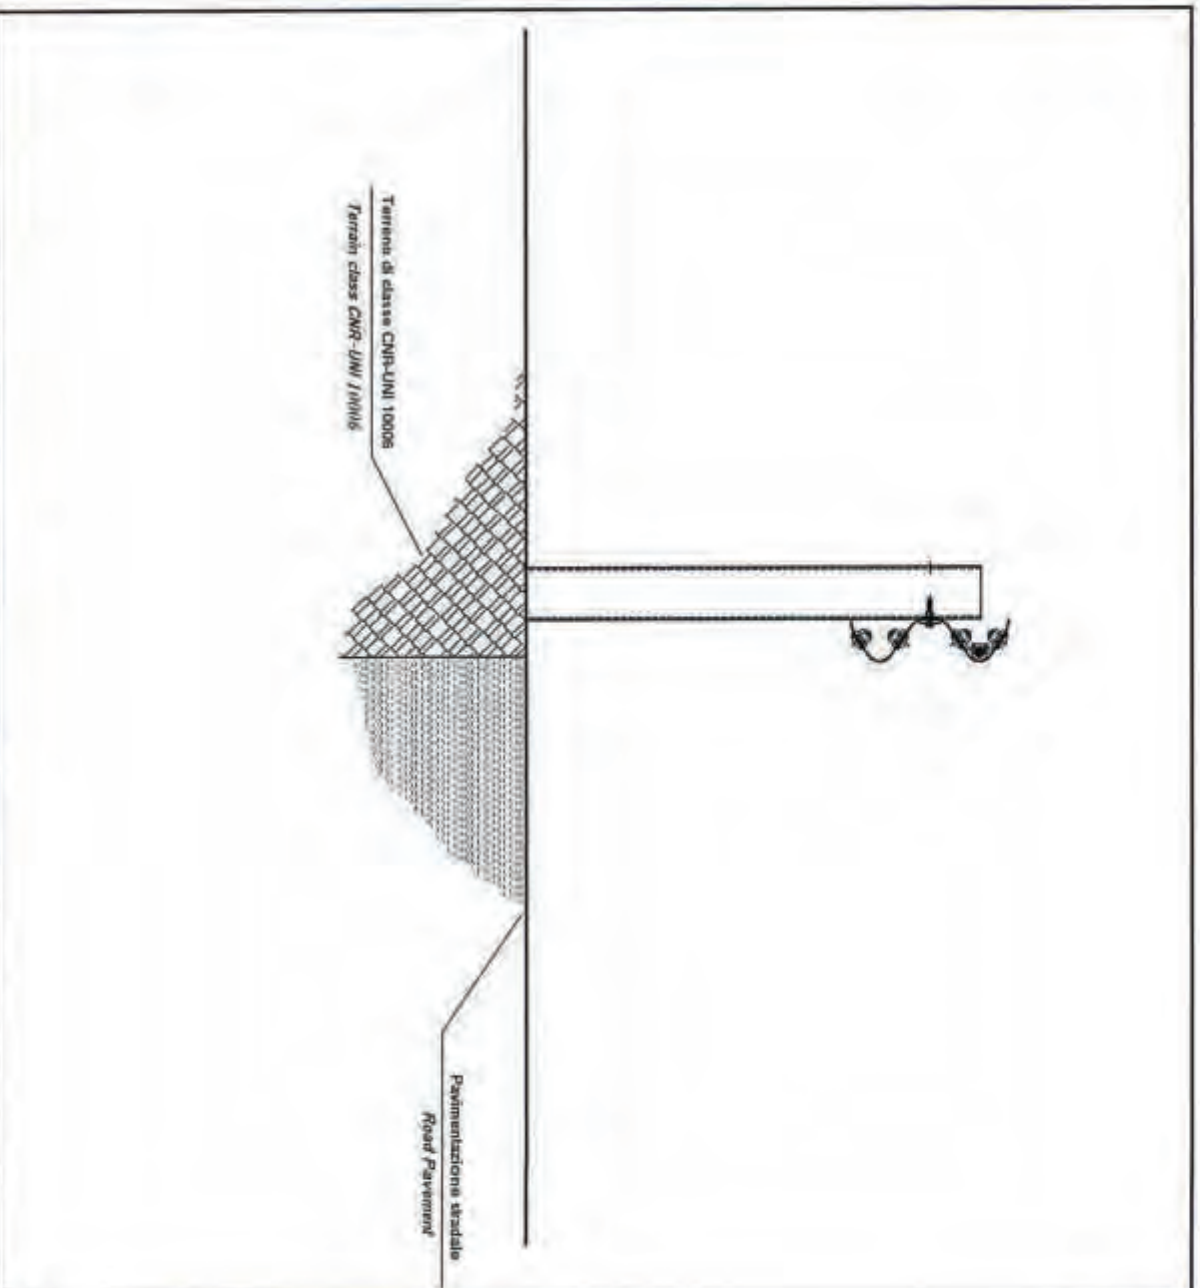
Figure 2 Sezione dell'installazione – The installation section
